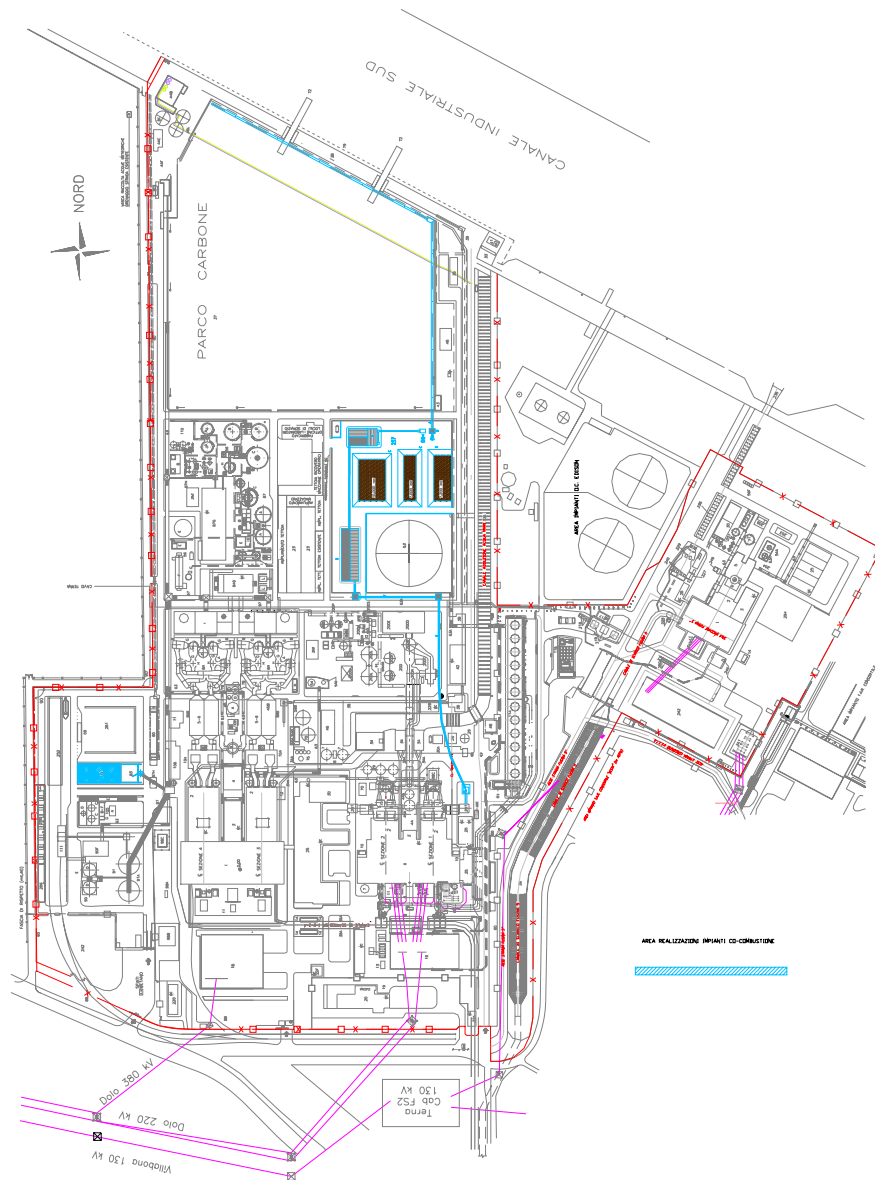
Vista della centrale termoelettrica "Andrea Palladio" di Fusina con indicazione delle aree d'intervento
